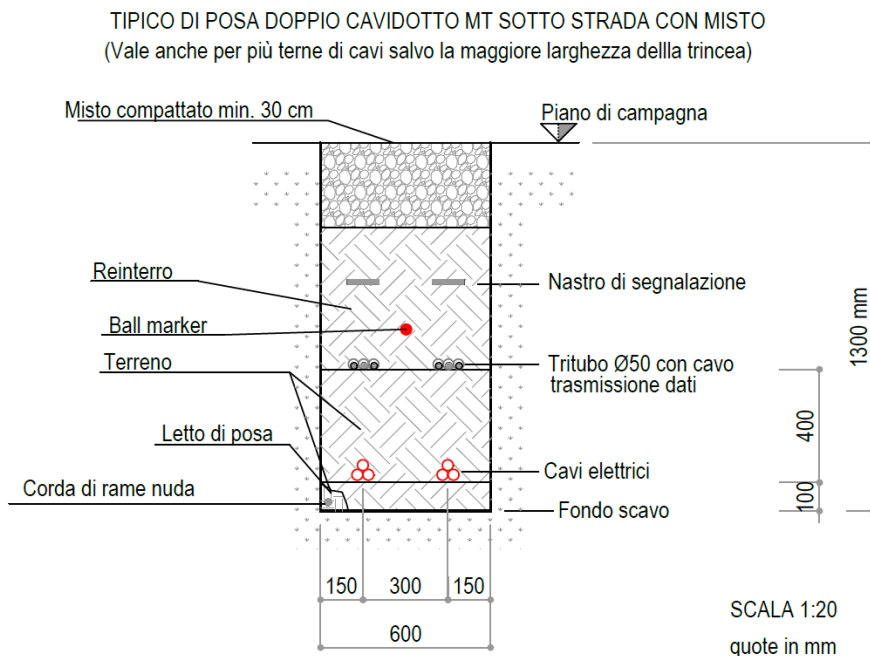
Tipico posa cavidotto su sterrato con 2 terne
